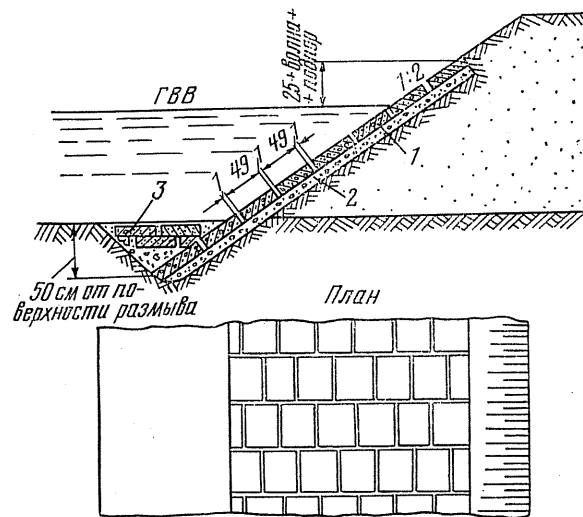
Укрепление откоса и подошвы дамбы цементобетонными плитами: 1 — бетонные плиты $49 \times 49 \times (8-12)$ см; 2 — щебеночная или гравийная подготовка 10—15 см; 3 — рисберма из бетонных плит $49 \times 49 \times (8-12)$ см
